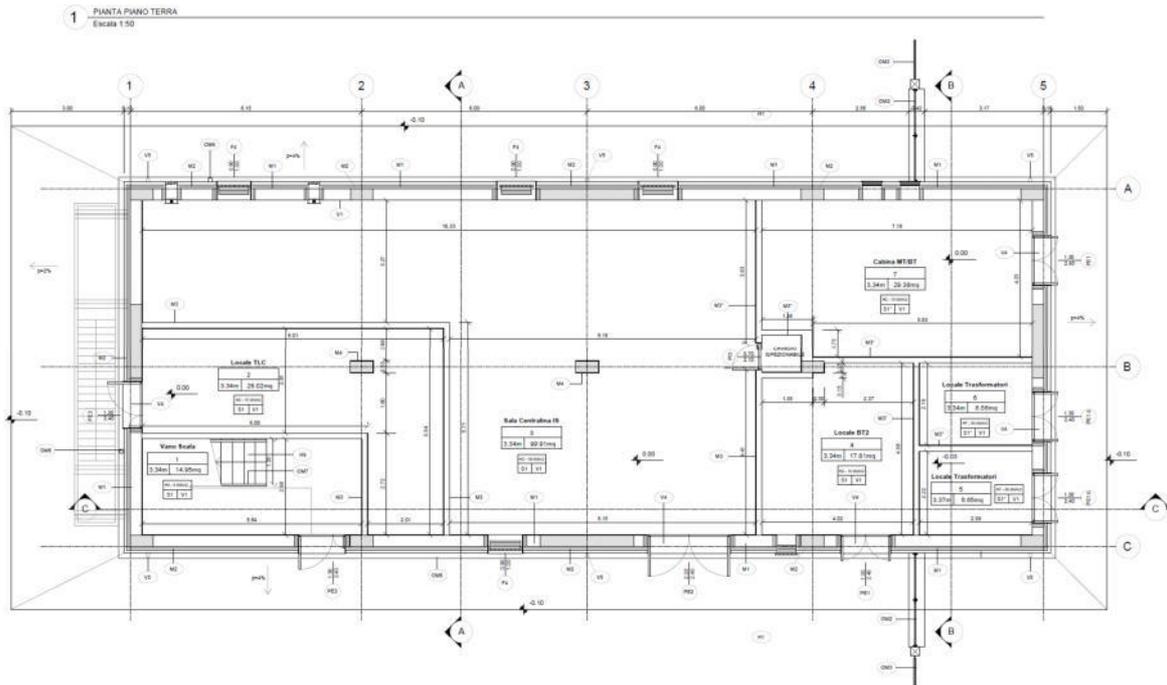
Pianta piano terra fabbricato F/PPT (FA-D)
